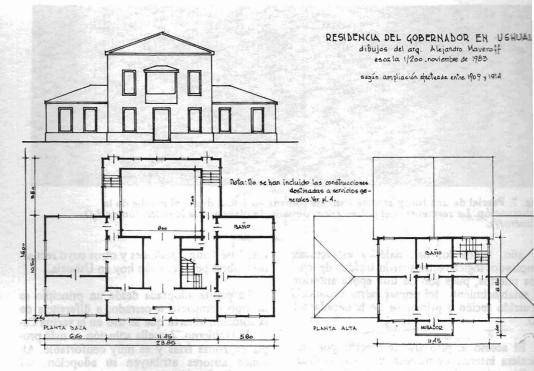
Reconstrucción de la residencia, con planta baja y primer piso, propuesta por el autor.
